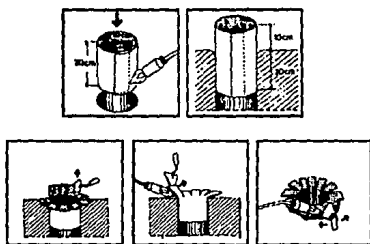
Tratamiento de bajadas pluviales<sup>6</sup>.
